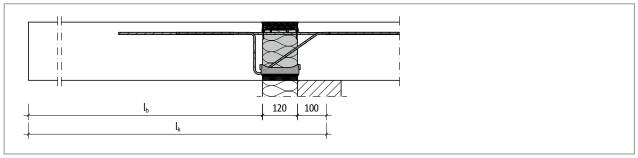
Schöck Isokorb $^{\circ}$ XT tipo K: Longitud de voladizo del sistema (l_{k}) para el cálculo y la longitud geométrica del voladizo (l_{b})
